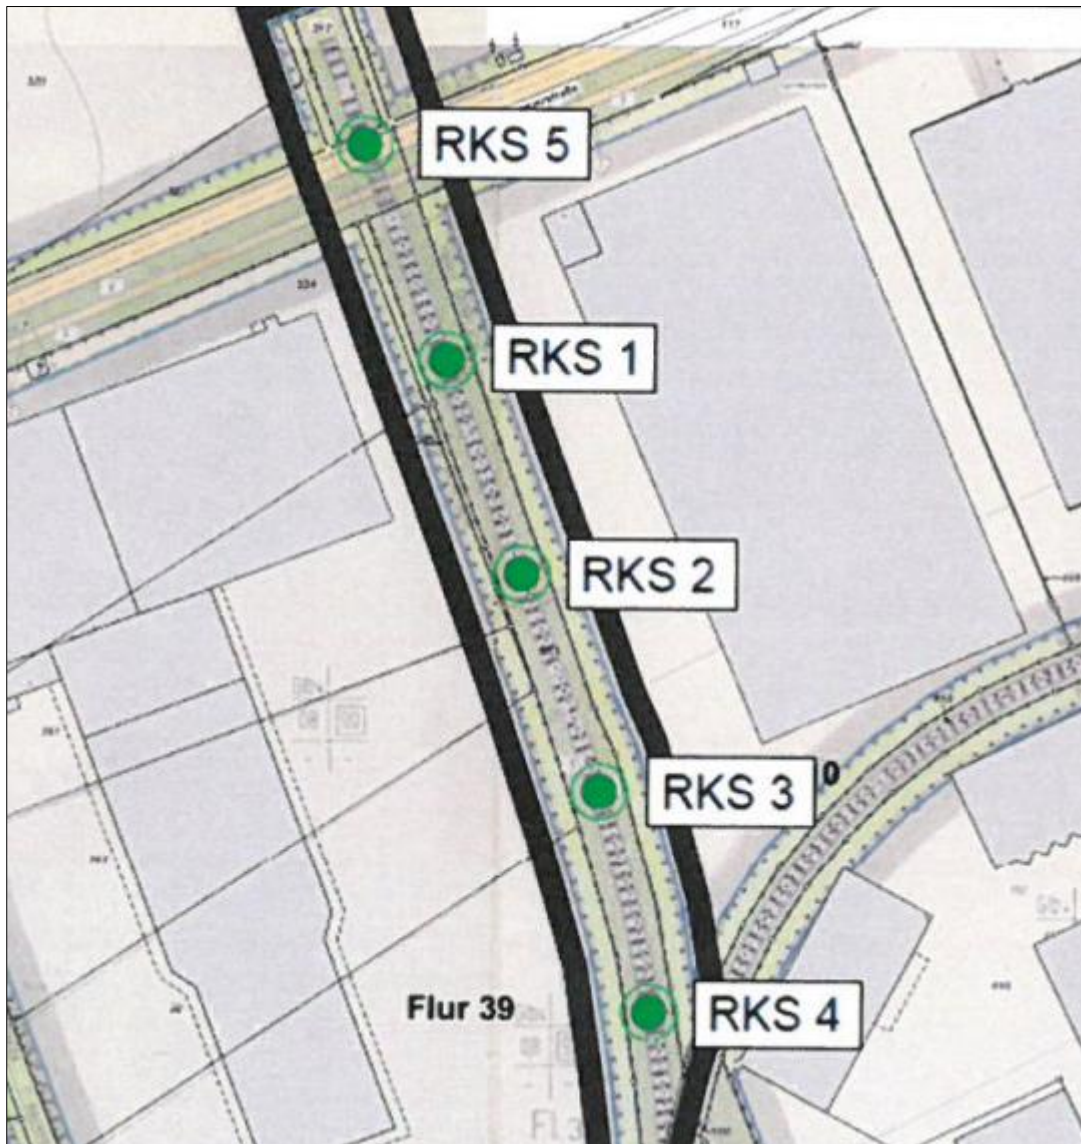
Auszug B-Plan UN 30 „Heidestraße“ der Stadt Unna mit Eintragung der erfolgten Erkundungsbohrungen (KIB 2021)
